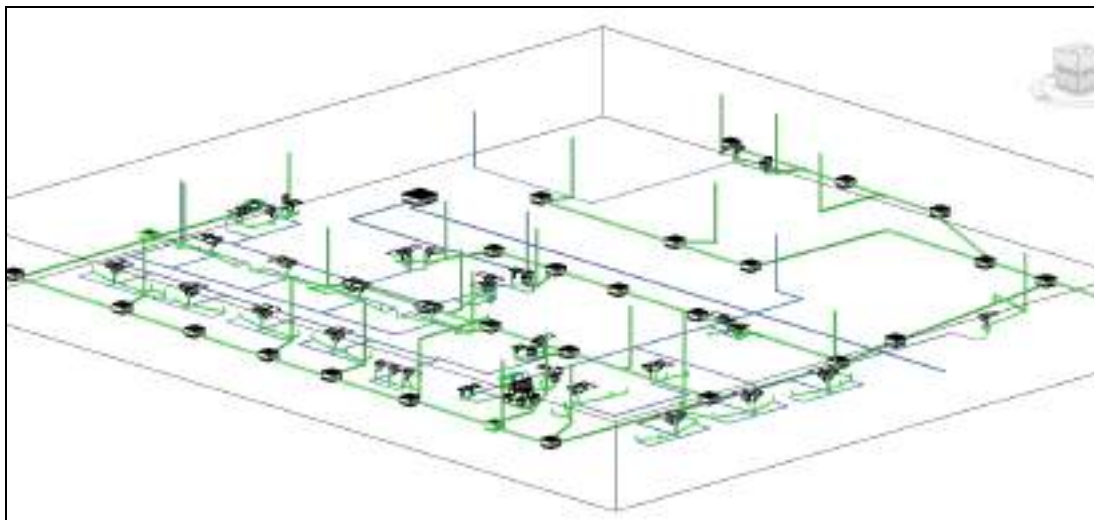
Modelado de instalaciones Sanitarias (Planta Baja), vista en 3D.
